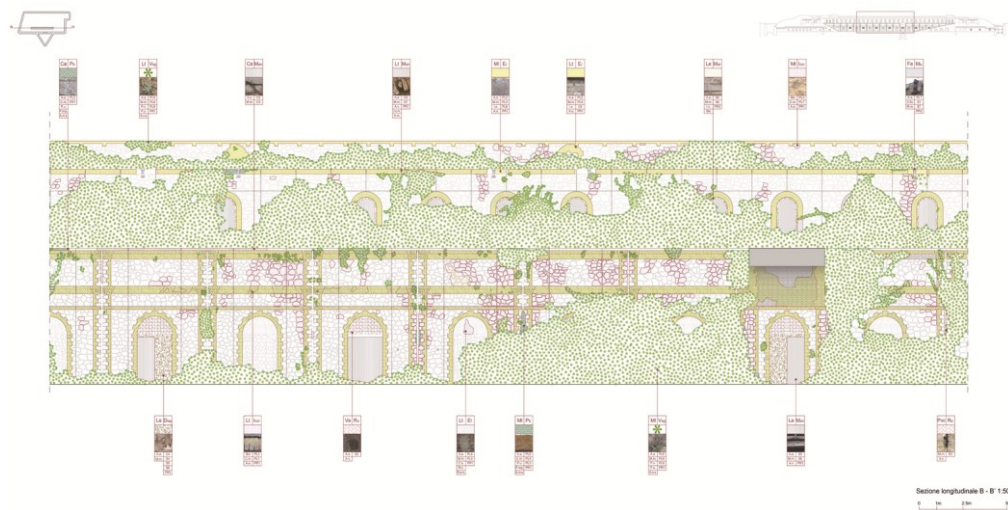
Forte Siacci: sezione / prospetto longitudinale della trincea con l'individuazione dei degradi
